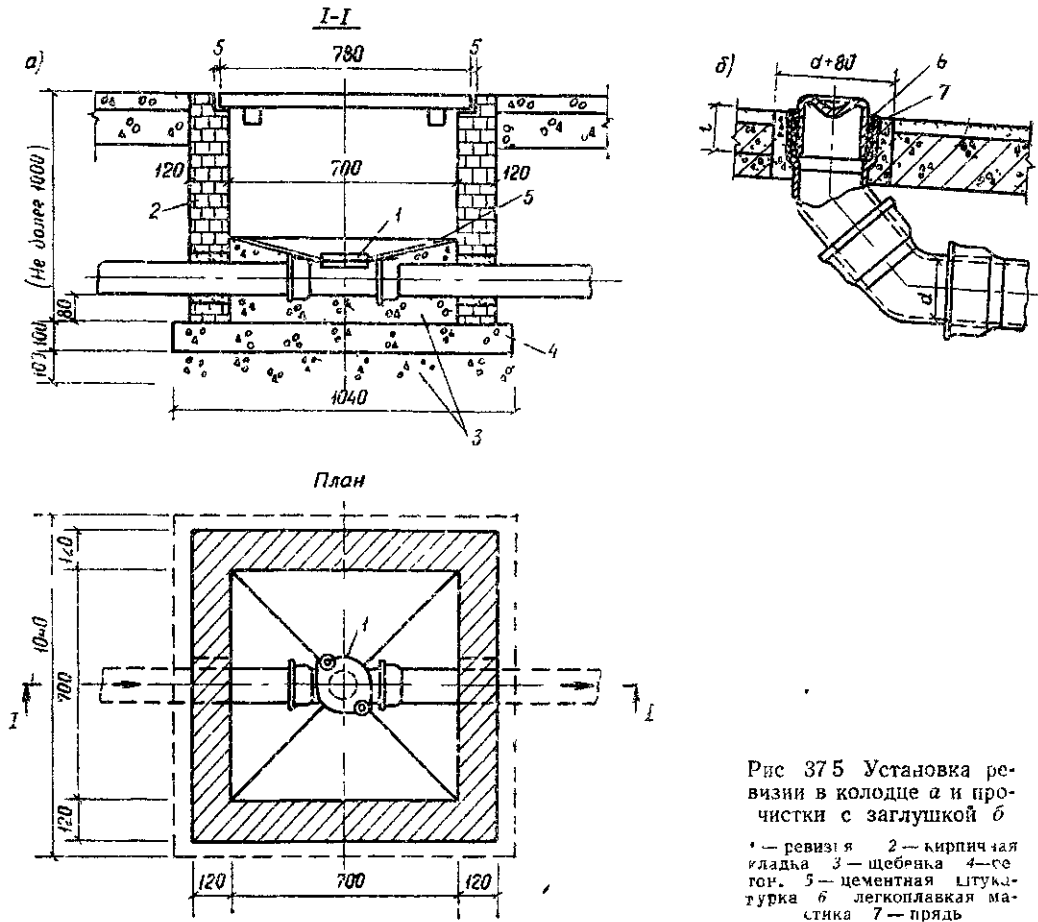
Установка ревизии в колодце а и прочистки с заглушкой б
